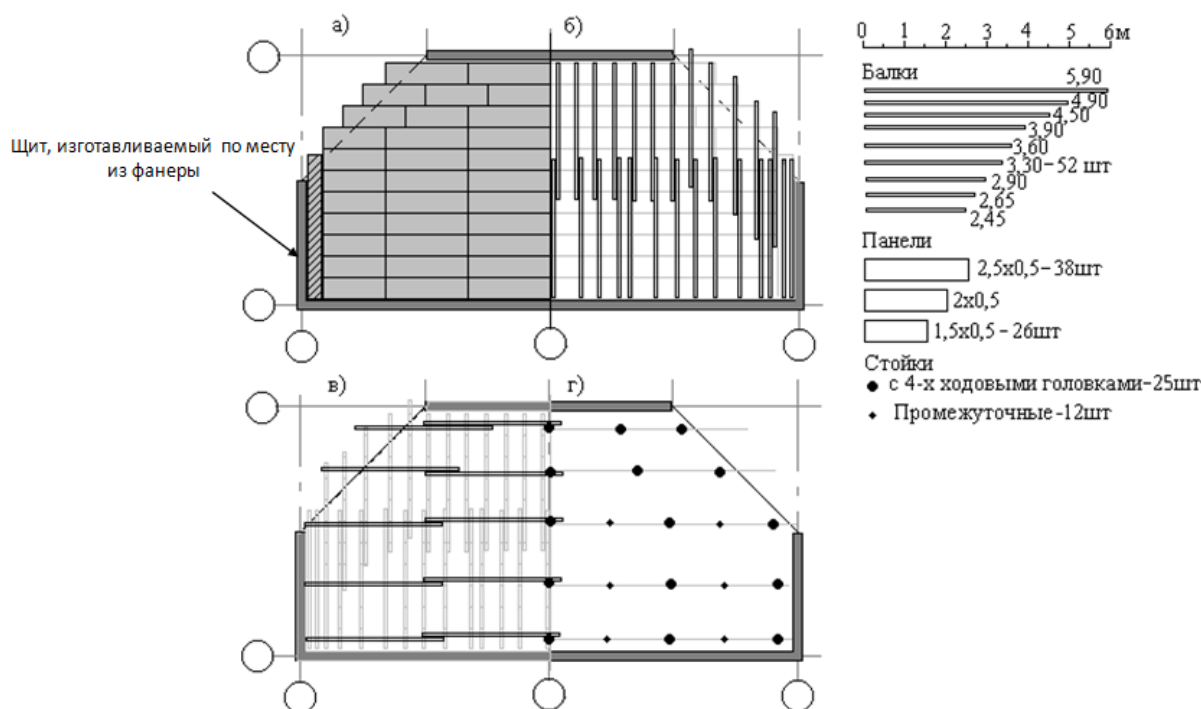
Пример сборки горизонтальной опалубки: а – план полуфрагмента с раскладкой стандартных щитов (вторая половина – зеркально); б – план раскладки балок верхнего пояса на контурном плане щитов; в – план раскладки основных балок на контурном плане балок верхнего пояса; г – план расстановки стоек
